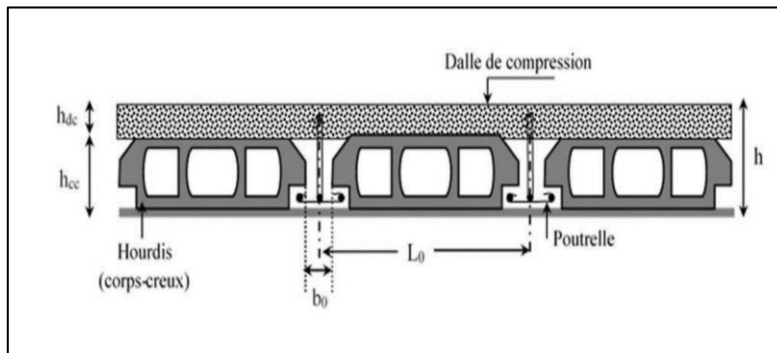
Coupe transversale d'un plancher à corps creux.
